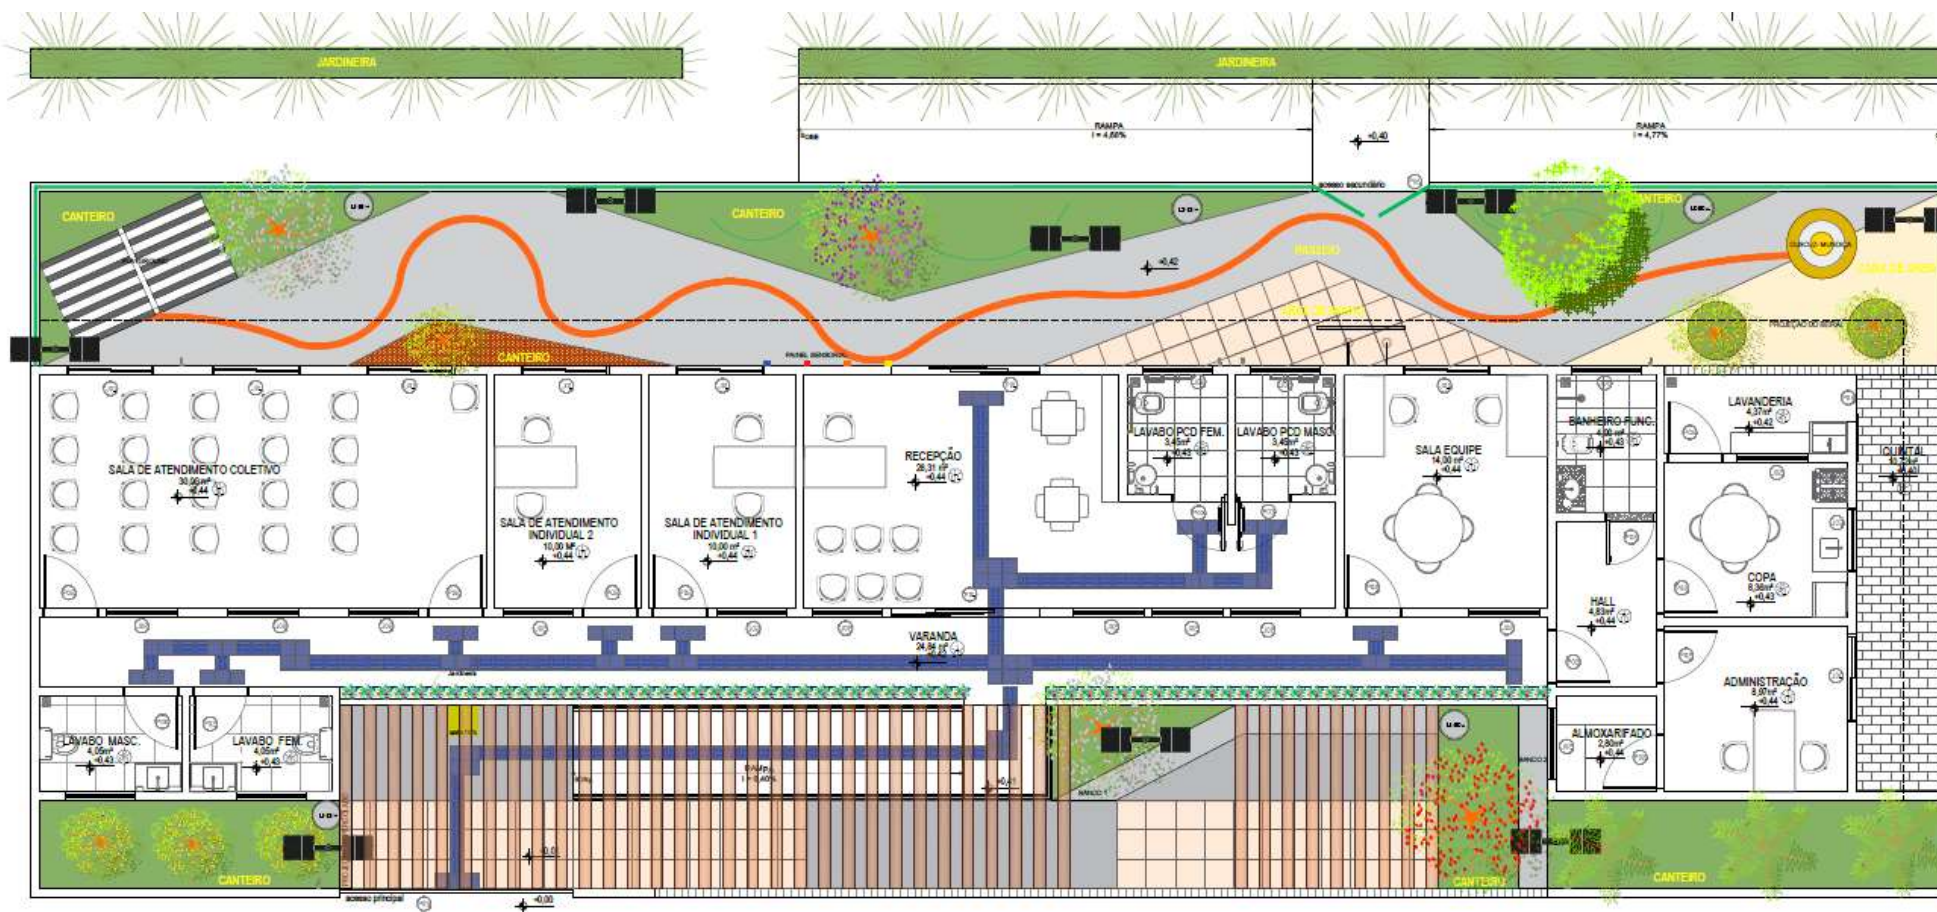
Planta de Layout. Fonte: Elaborado pela autora do projeto, 2024.
